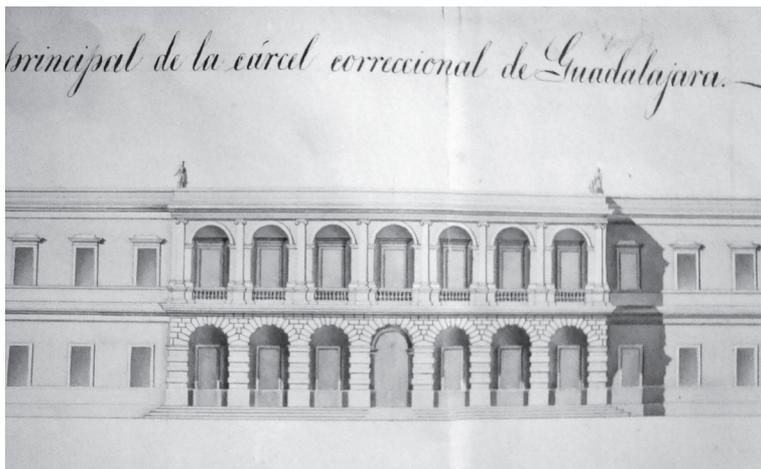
Plano de la Cárcel Correccional de Guadalajara. Fragmento del alzado que muestra la fachada original, luego sustituida por la que aparece en las figuras 4 y 5. Destacan las esculturas que rematan el edificio, la del lado derecho es la representación de una mujer con un niño, imagen similar a la que aparece en la pintura del jardín botánico observable en figura 6. Fuente: Mapoteca Orozco y Berra, cédula 1449-OYB-7233.
